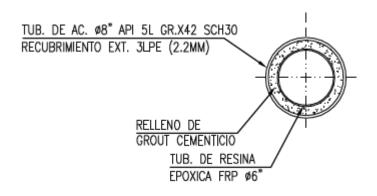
Sistema de tuberías de paredes múltiples tamaño 6"x 8"
